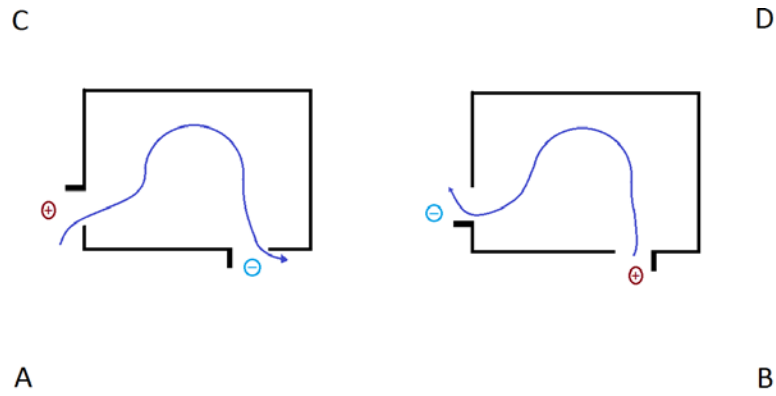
Exemplos do uso de deflectores para aberturas de ventilação em duas fachadas, para a promoção de ventilação cruzada (Adaptado de Verdelho, 2008).
